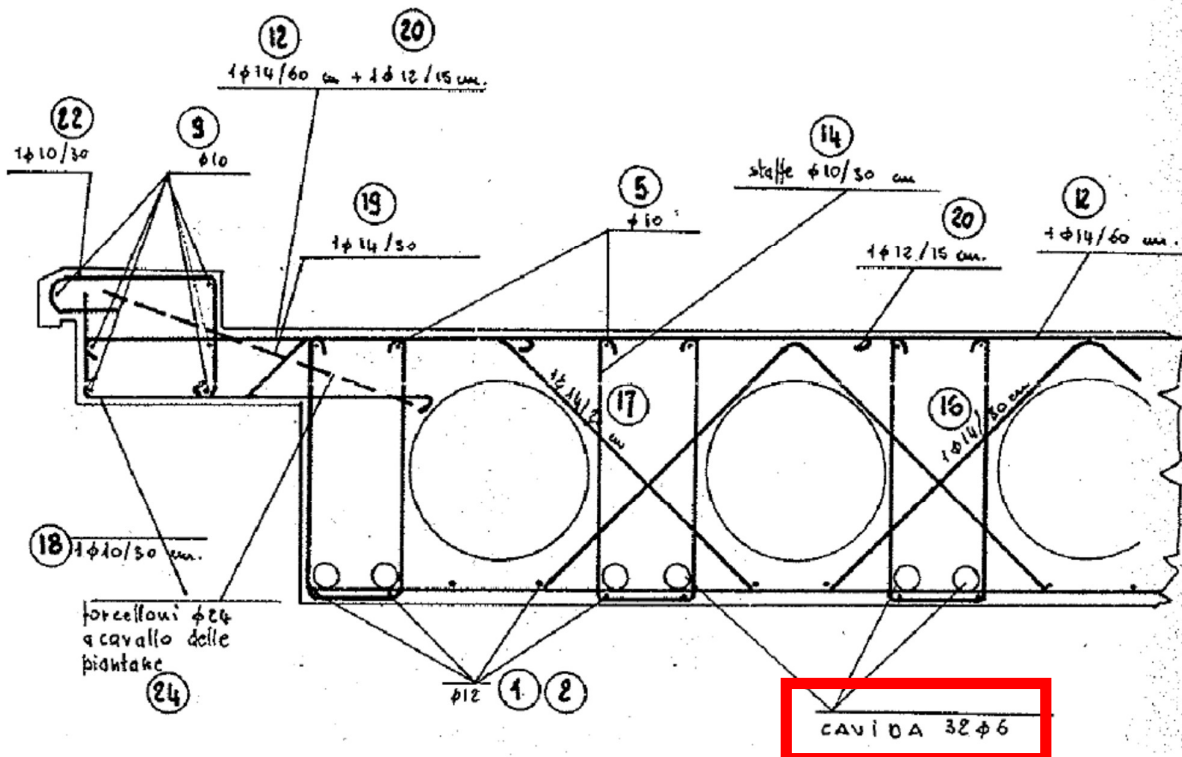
Sezione trasversale della soletta con armature (Tavole di progetto opera originale)
